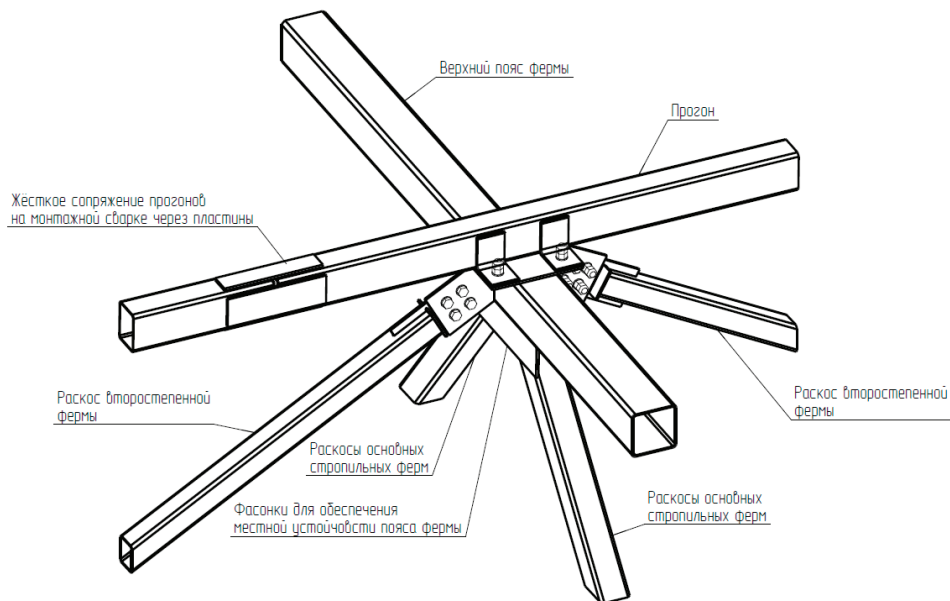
Конструкция узла крепления неразрезного прогона к верхнему поясу фермы
